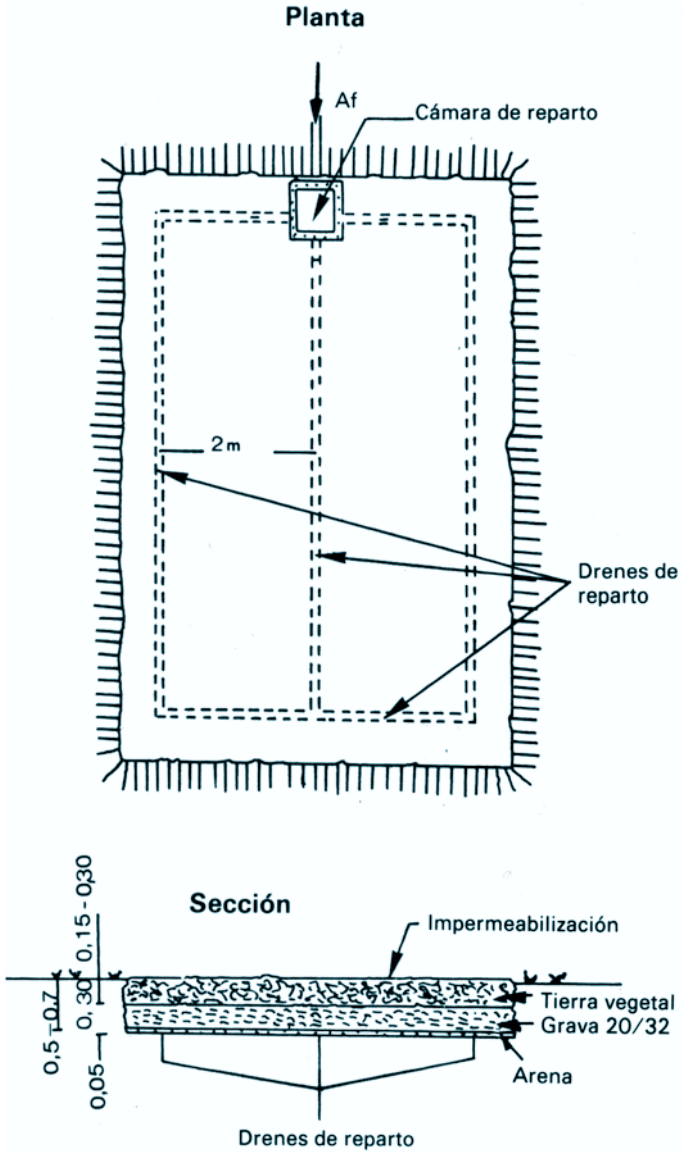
Características constructivas de un lecho filtrante (Rouhart, J., 1986)
